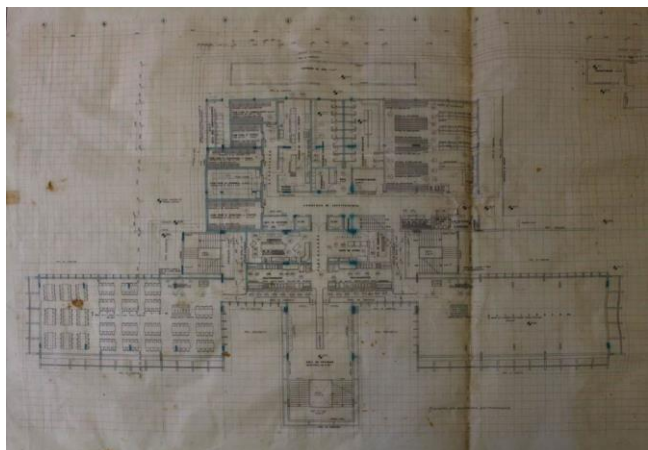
Planta Primeiro Pavimento RU, 1977. Fonte: Acervo SUMAI.
